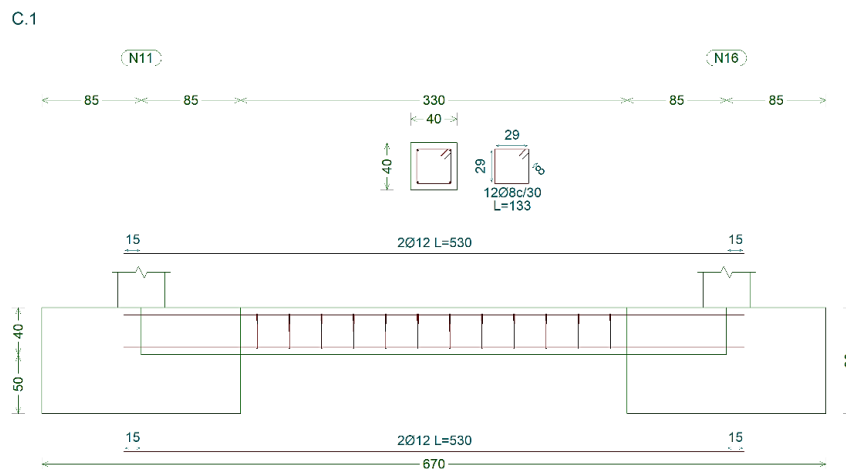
Dimensiones viga de atado. (Fuente CYPE 3D).
